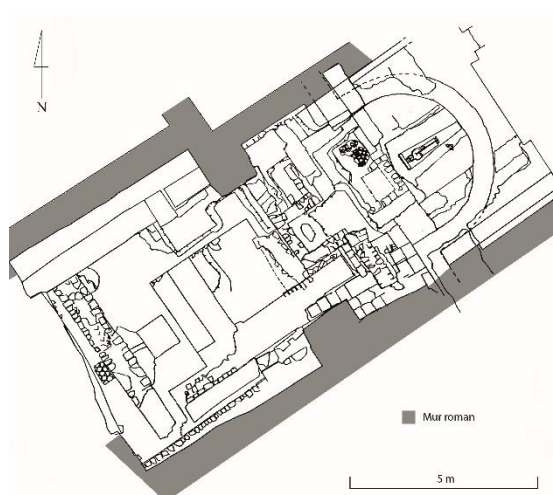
Fondations des murs romans toujours en fonction, vue en plan (section O et Q)
